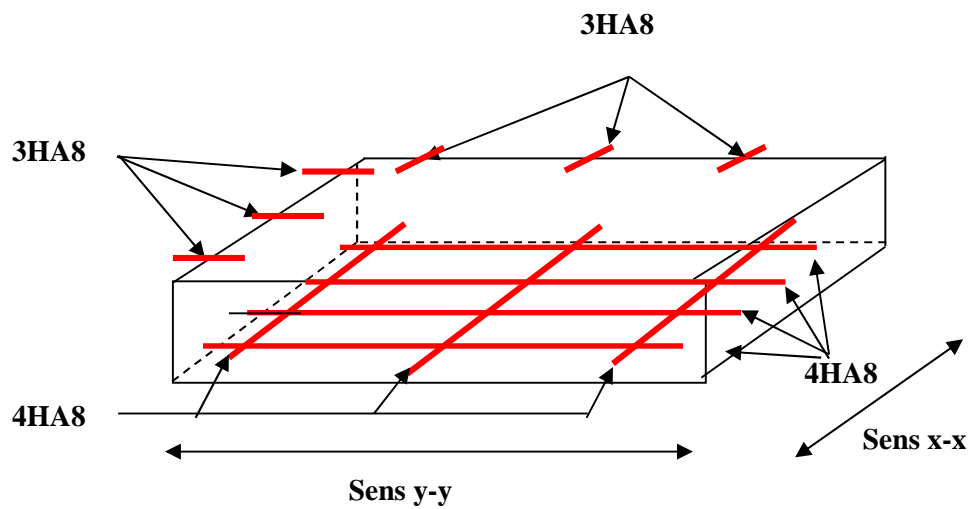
Schéma de ferrailage de la dalle pleine au-dessous de l'ascenseur.
